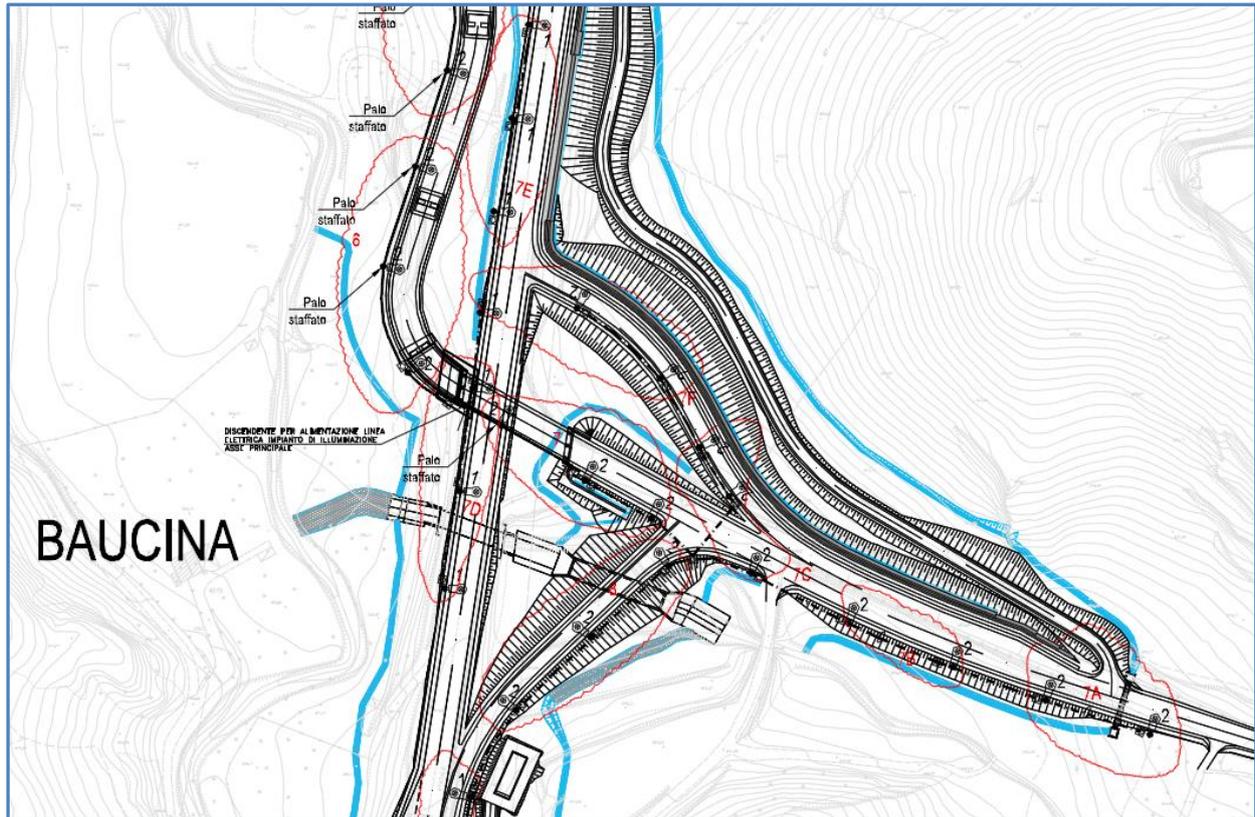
Stralcio planimetrico impianto di illuminazione Svincolo Baucina aggiornato.
